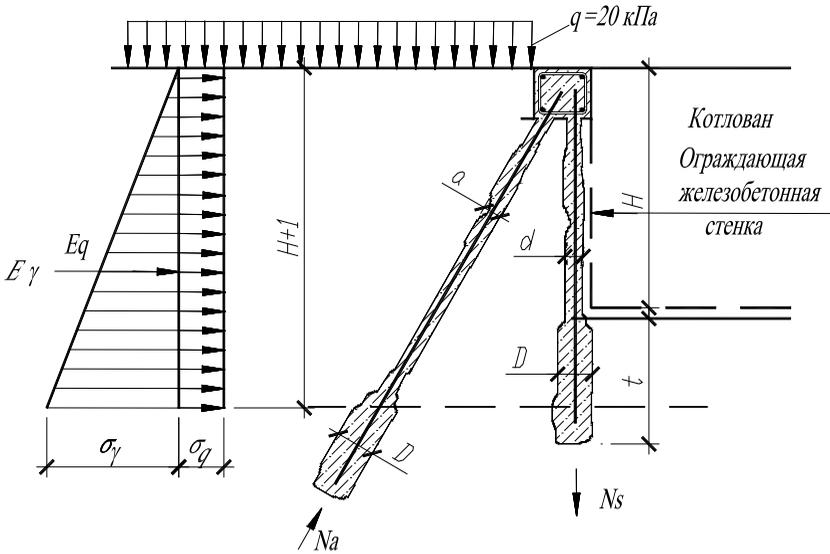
Расчетная схема козловой системы ограждения котлована
